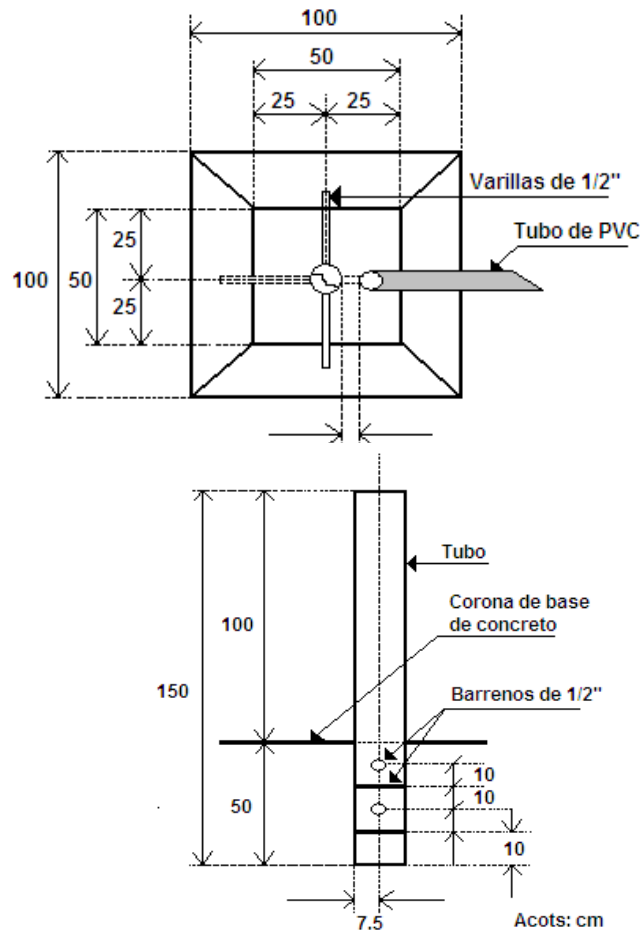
Localización del barreno y planta de la base de la antena.
